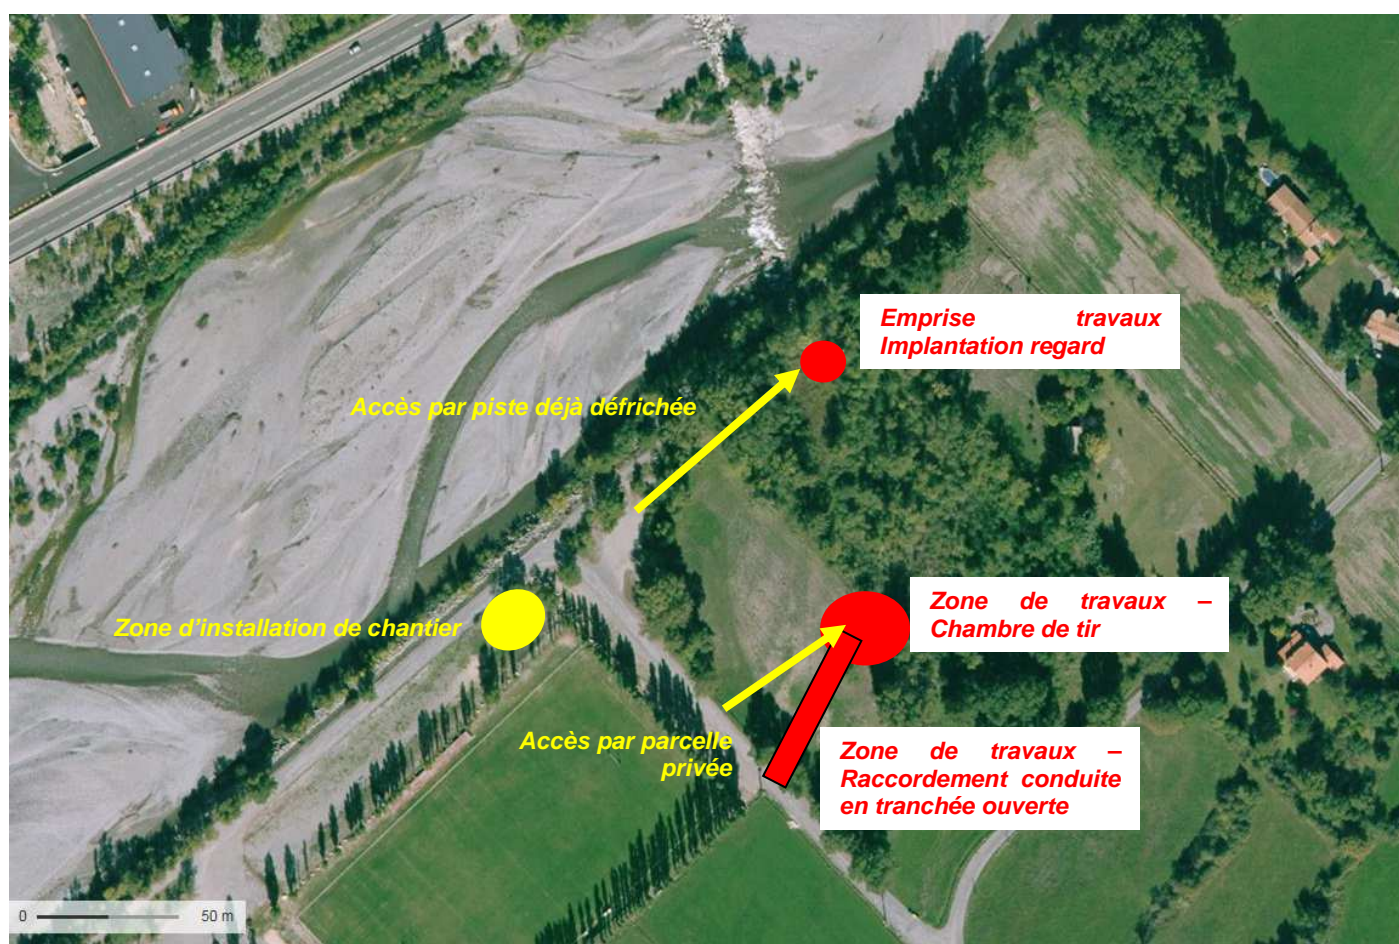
Accès et installation de chantier pour les travaux liés à la conduite d'eaux usées – RIVE GAUCHE
